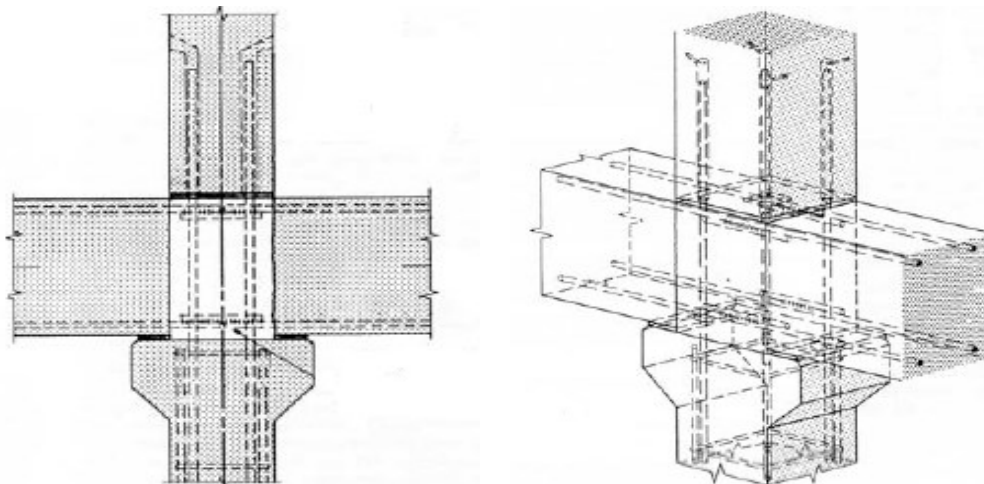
Ligação pilar – viga com interrupção do pilar (STUPRÉ, 1981).
